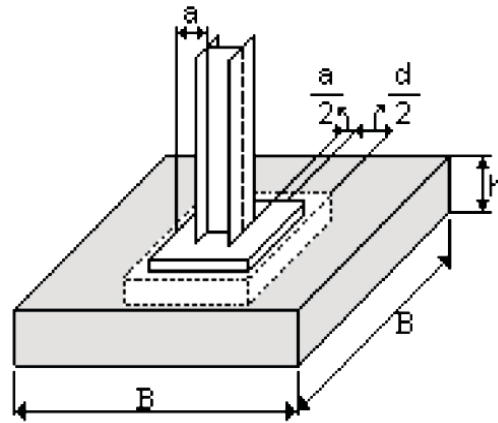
B CORTANTE BIDIRECCIONAL EN ZAPATA QUE SOPORTA COLUMNA METÁLICA.
